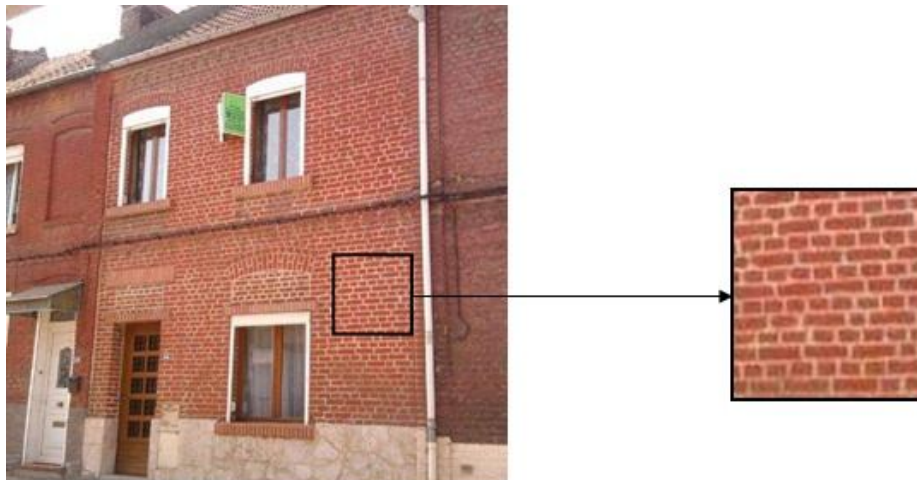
Façade extérieure d'une construction Lilloise typique (maison de ville)
